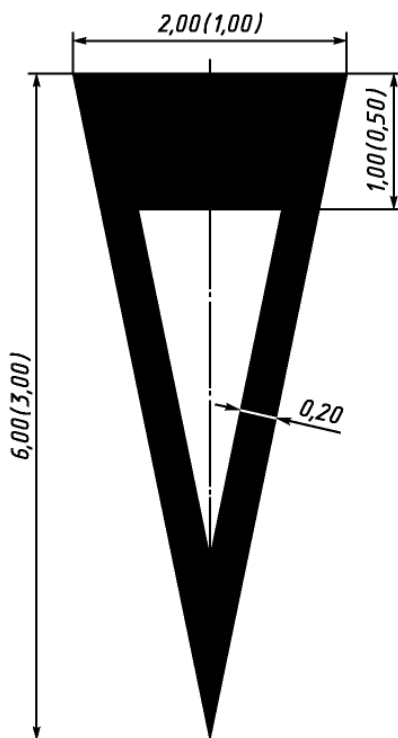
Форма, расположение и размеры стрел разметки типа 1.19
